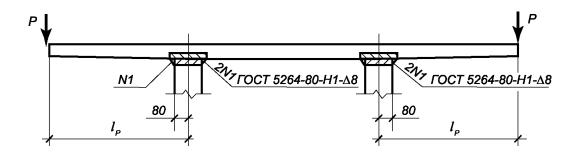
Схема испытания ступеней типоразмера ЛСС 24
